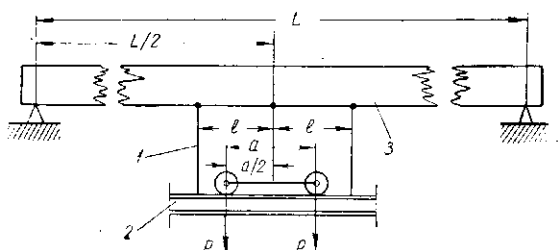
Схема к расчету однорельсовой подвесной дороги:
